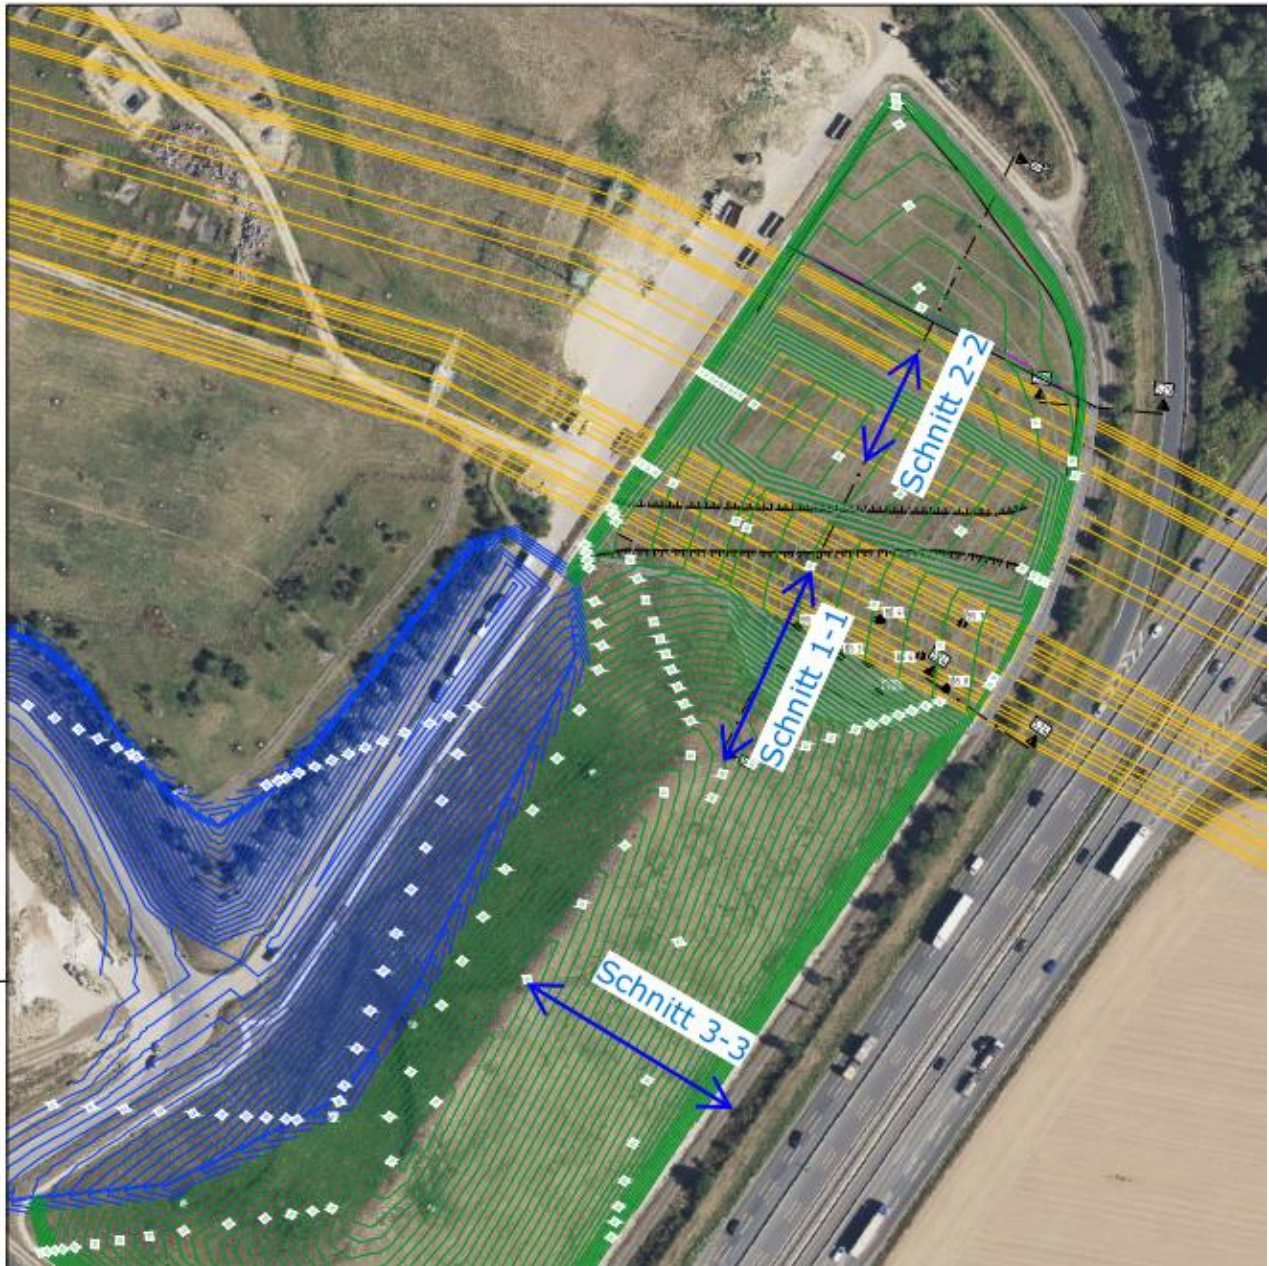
geplante Oberfläche Rekultivierungsschicht mit Schnittführung
